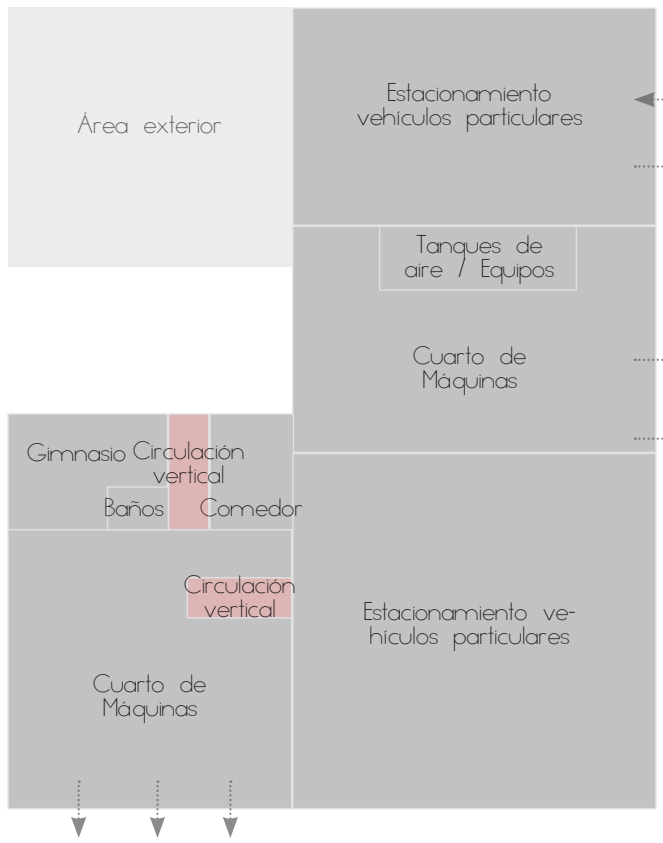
Zonificación planta baja estación N°5. (Autoras, 2019)
